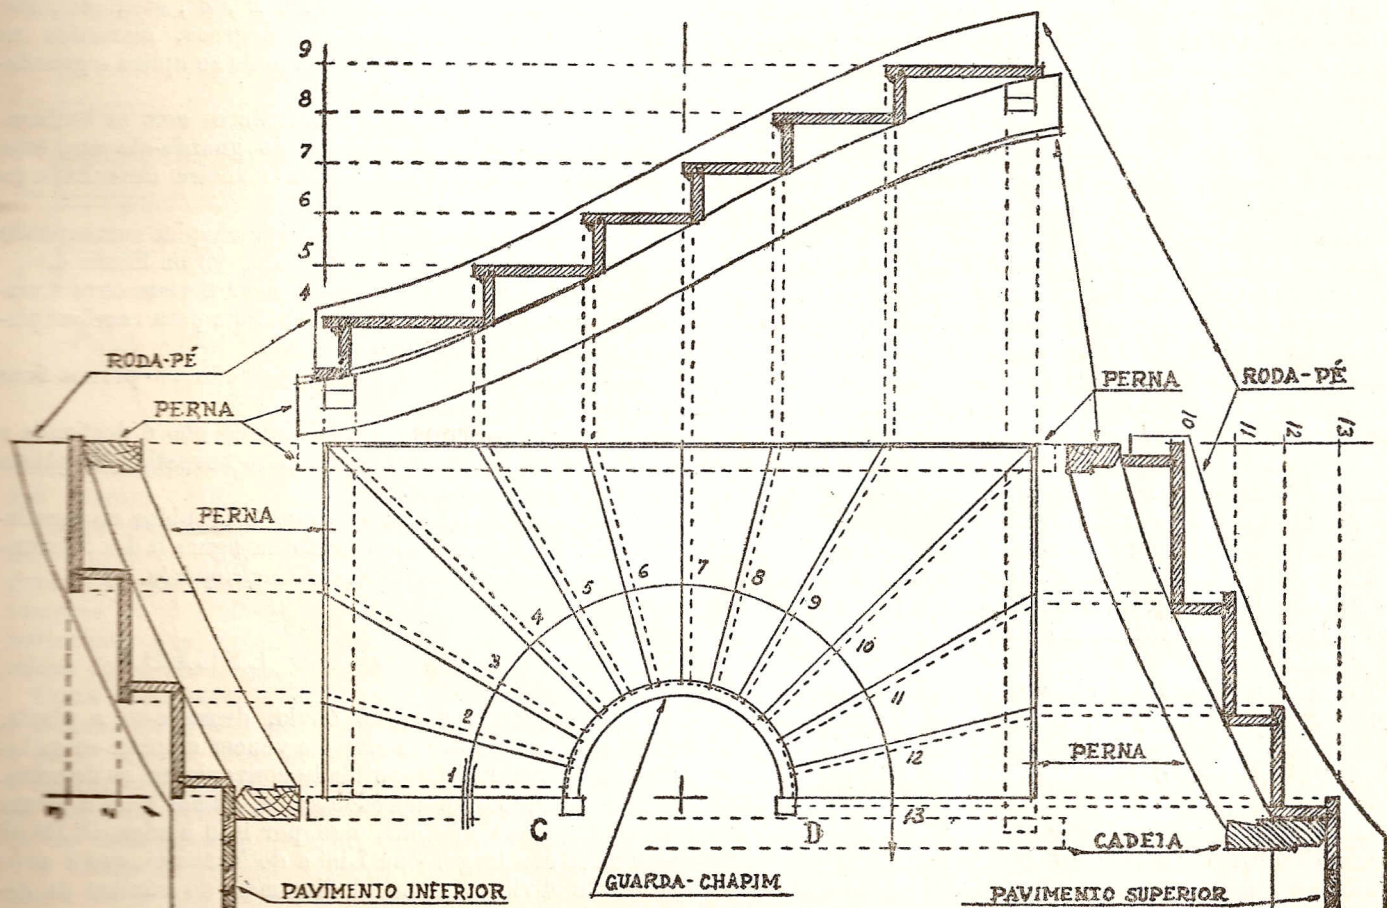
PLANTA DA ESCADA DE LEQUE ESTREITA
